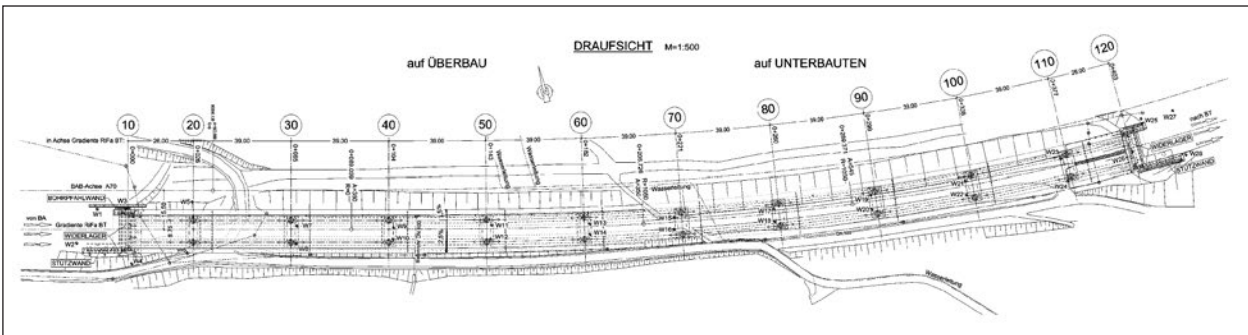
Draufsicht Hangbrücke Würgau mit Nordpfeilausrichtung
